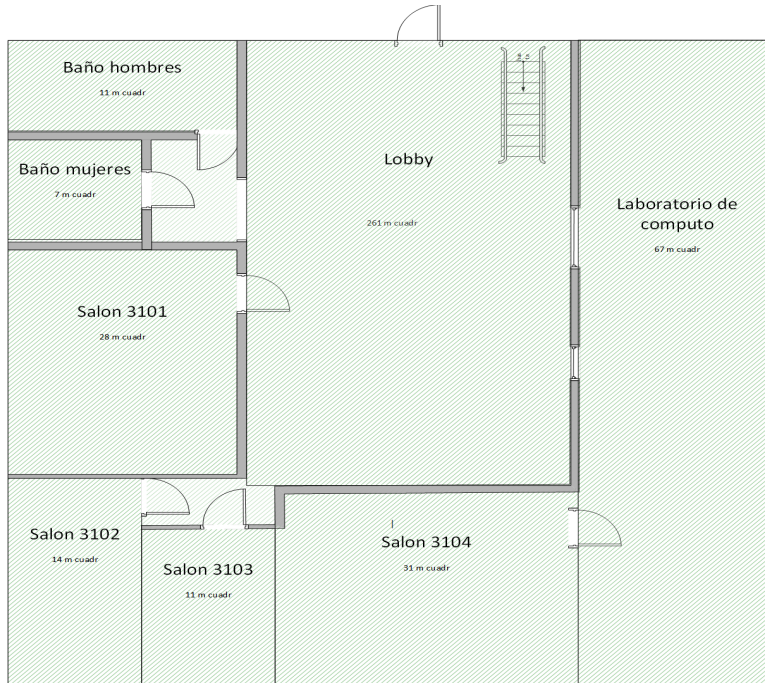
Planos de planta baja edificio de computación en Cenidet.
